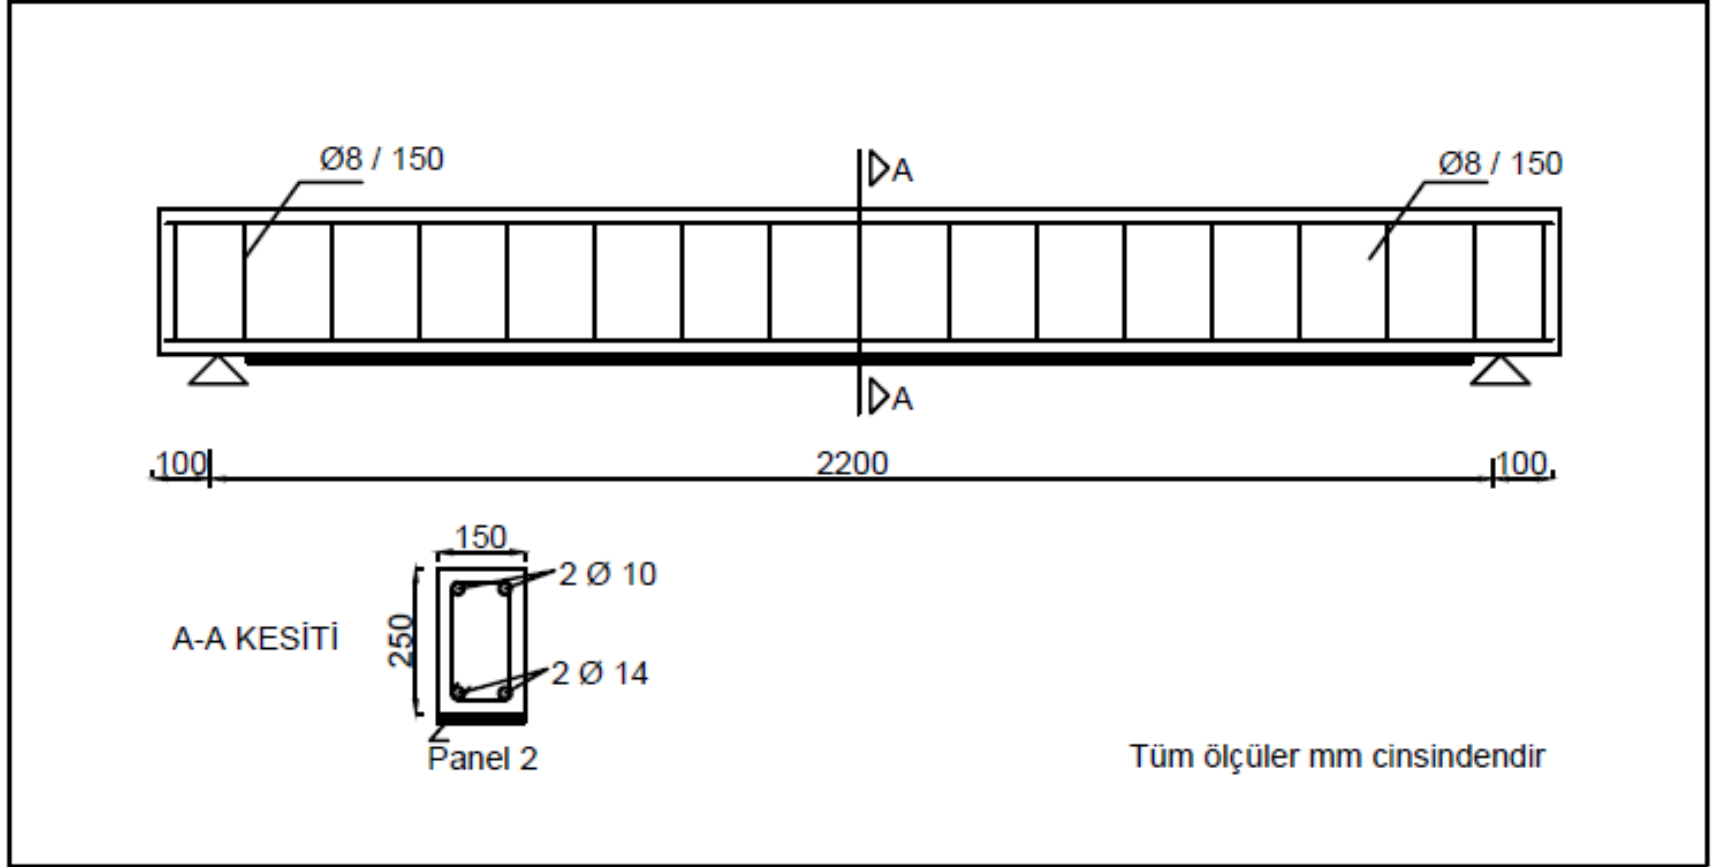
KY-1, KY-2 ve KY-3 deney elemanlarının detaylandırılması
